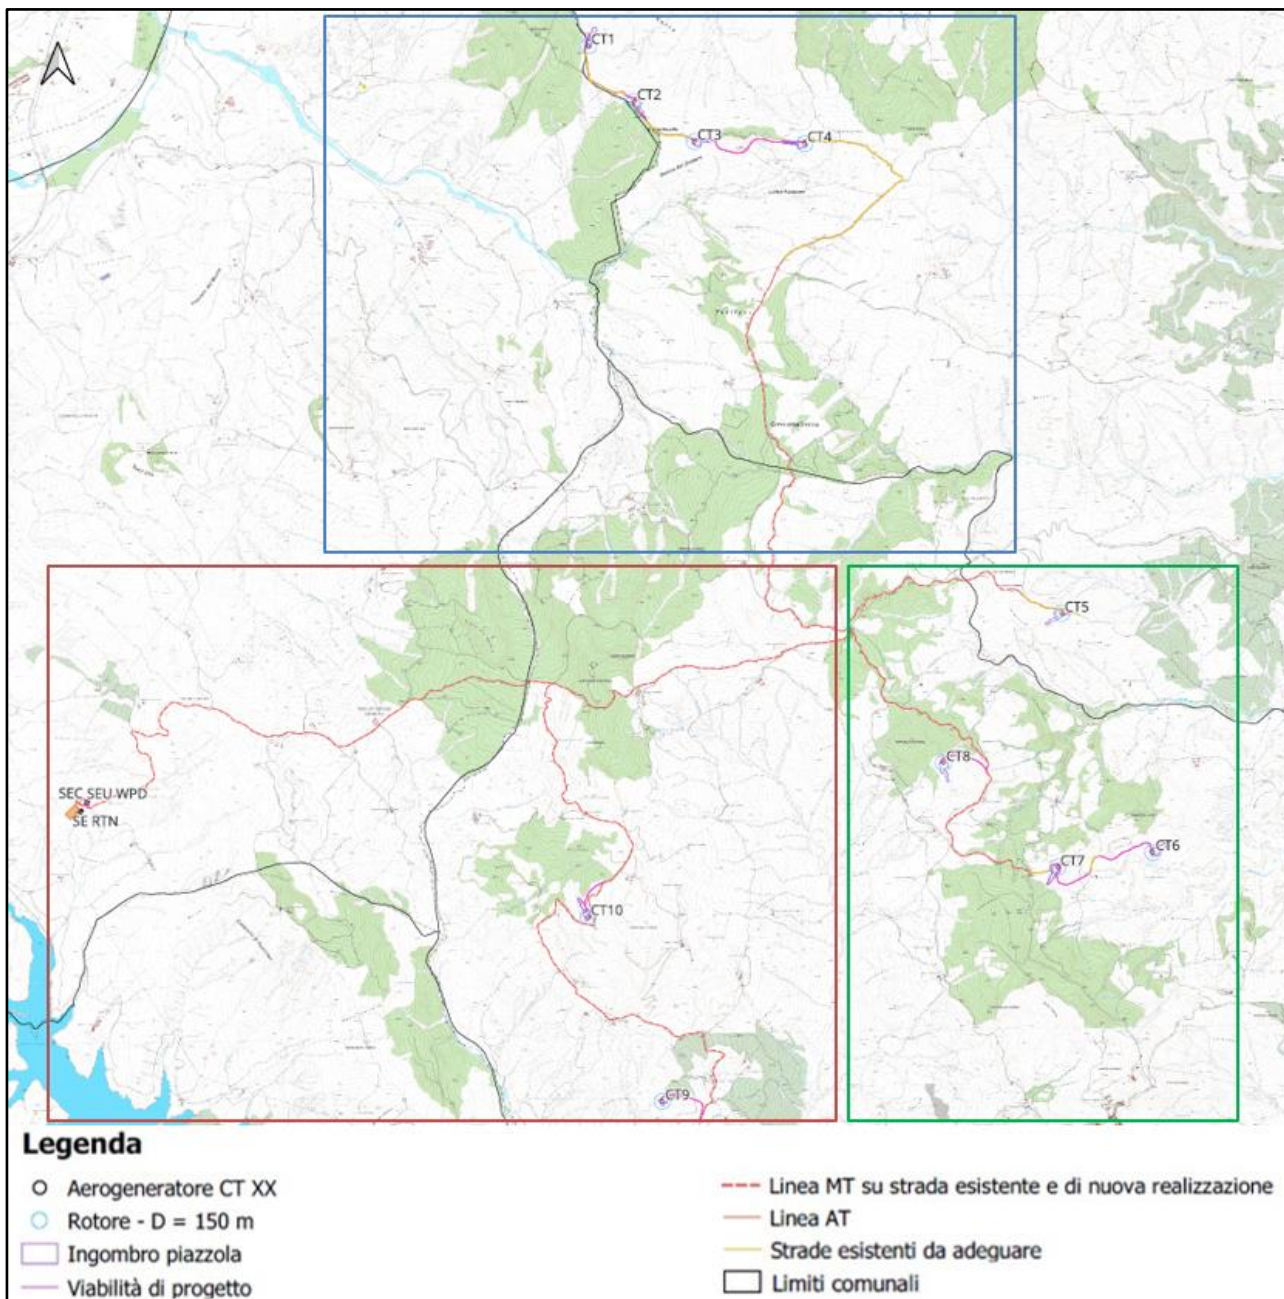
Layout d’impianto suddiviso in zone su CTR: Zona 1 - rettangolo rosso, Zona 2 - rettangolo azzurro, Zona 3 - rettangolo verde
